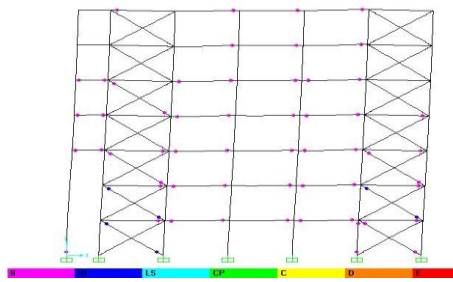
SRPMK lantai 7 arah X step 3 (Sumber Permodelan Sap2000)
